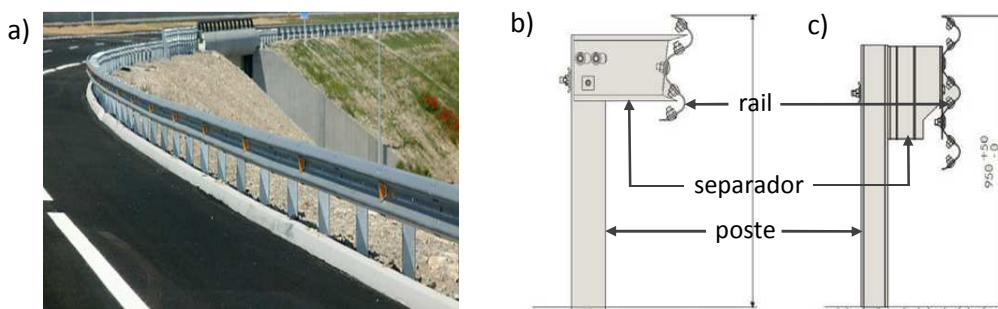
(a) barrera metálica en servicio y barreras (b) bi-onda y (c) tri-onda. (Fuente: GIVASA)
